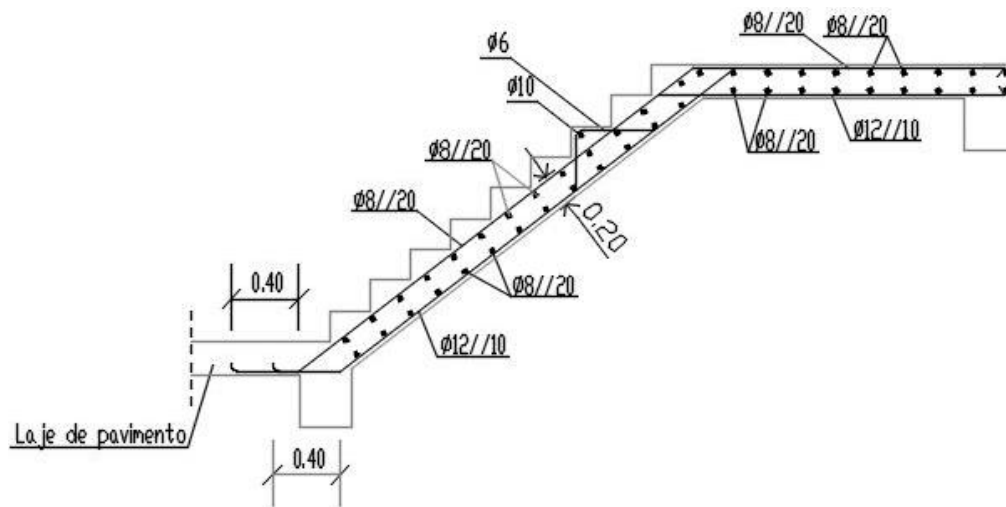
Pormenor das lajes de escadas: LE1.C.RC.1 E LE1.RC.P1.1.
